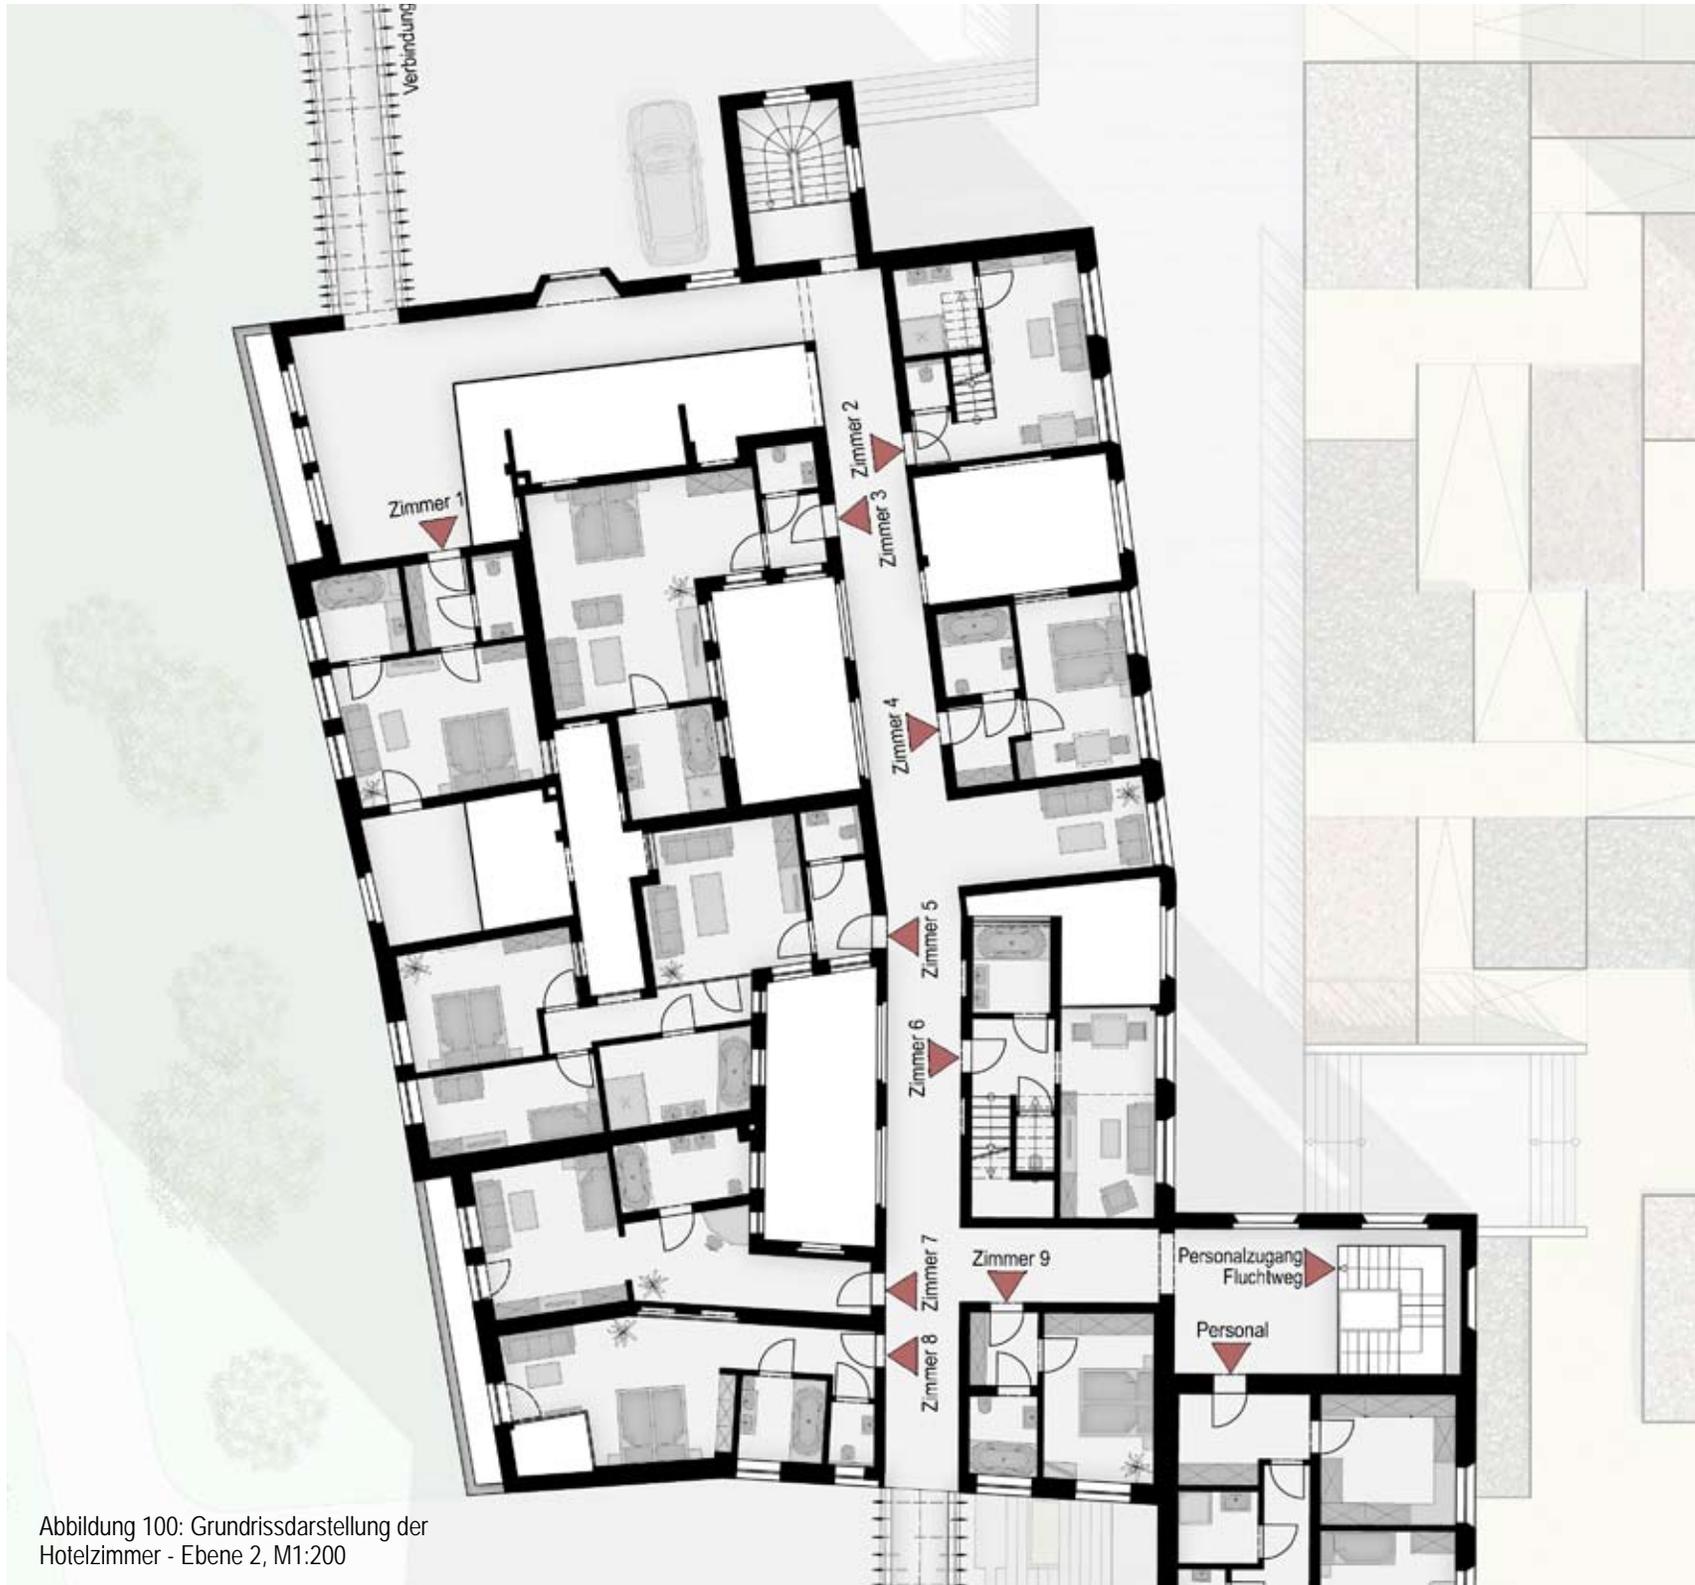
Grundrissdarstellung der Hotelzimmer - Ebene 2, M1:200
